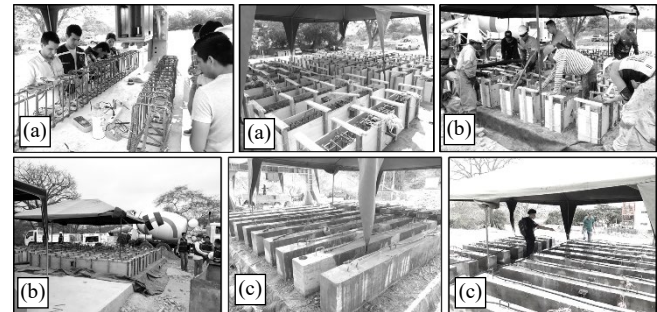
Fabricación de los especímenes de ensayo. (a) Armado e instrumentación interna (strain gauge) (b) Hormigonado y vibrado. (c) Curado.
